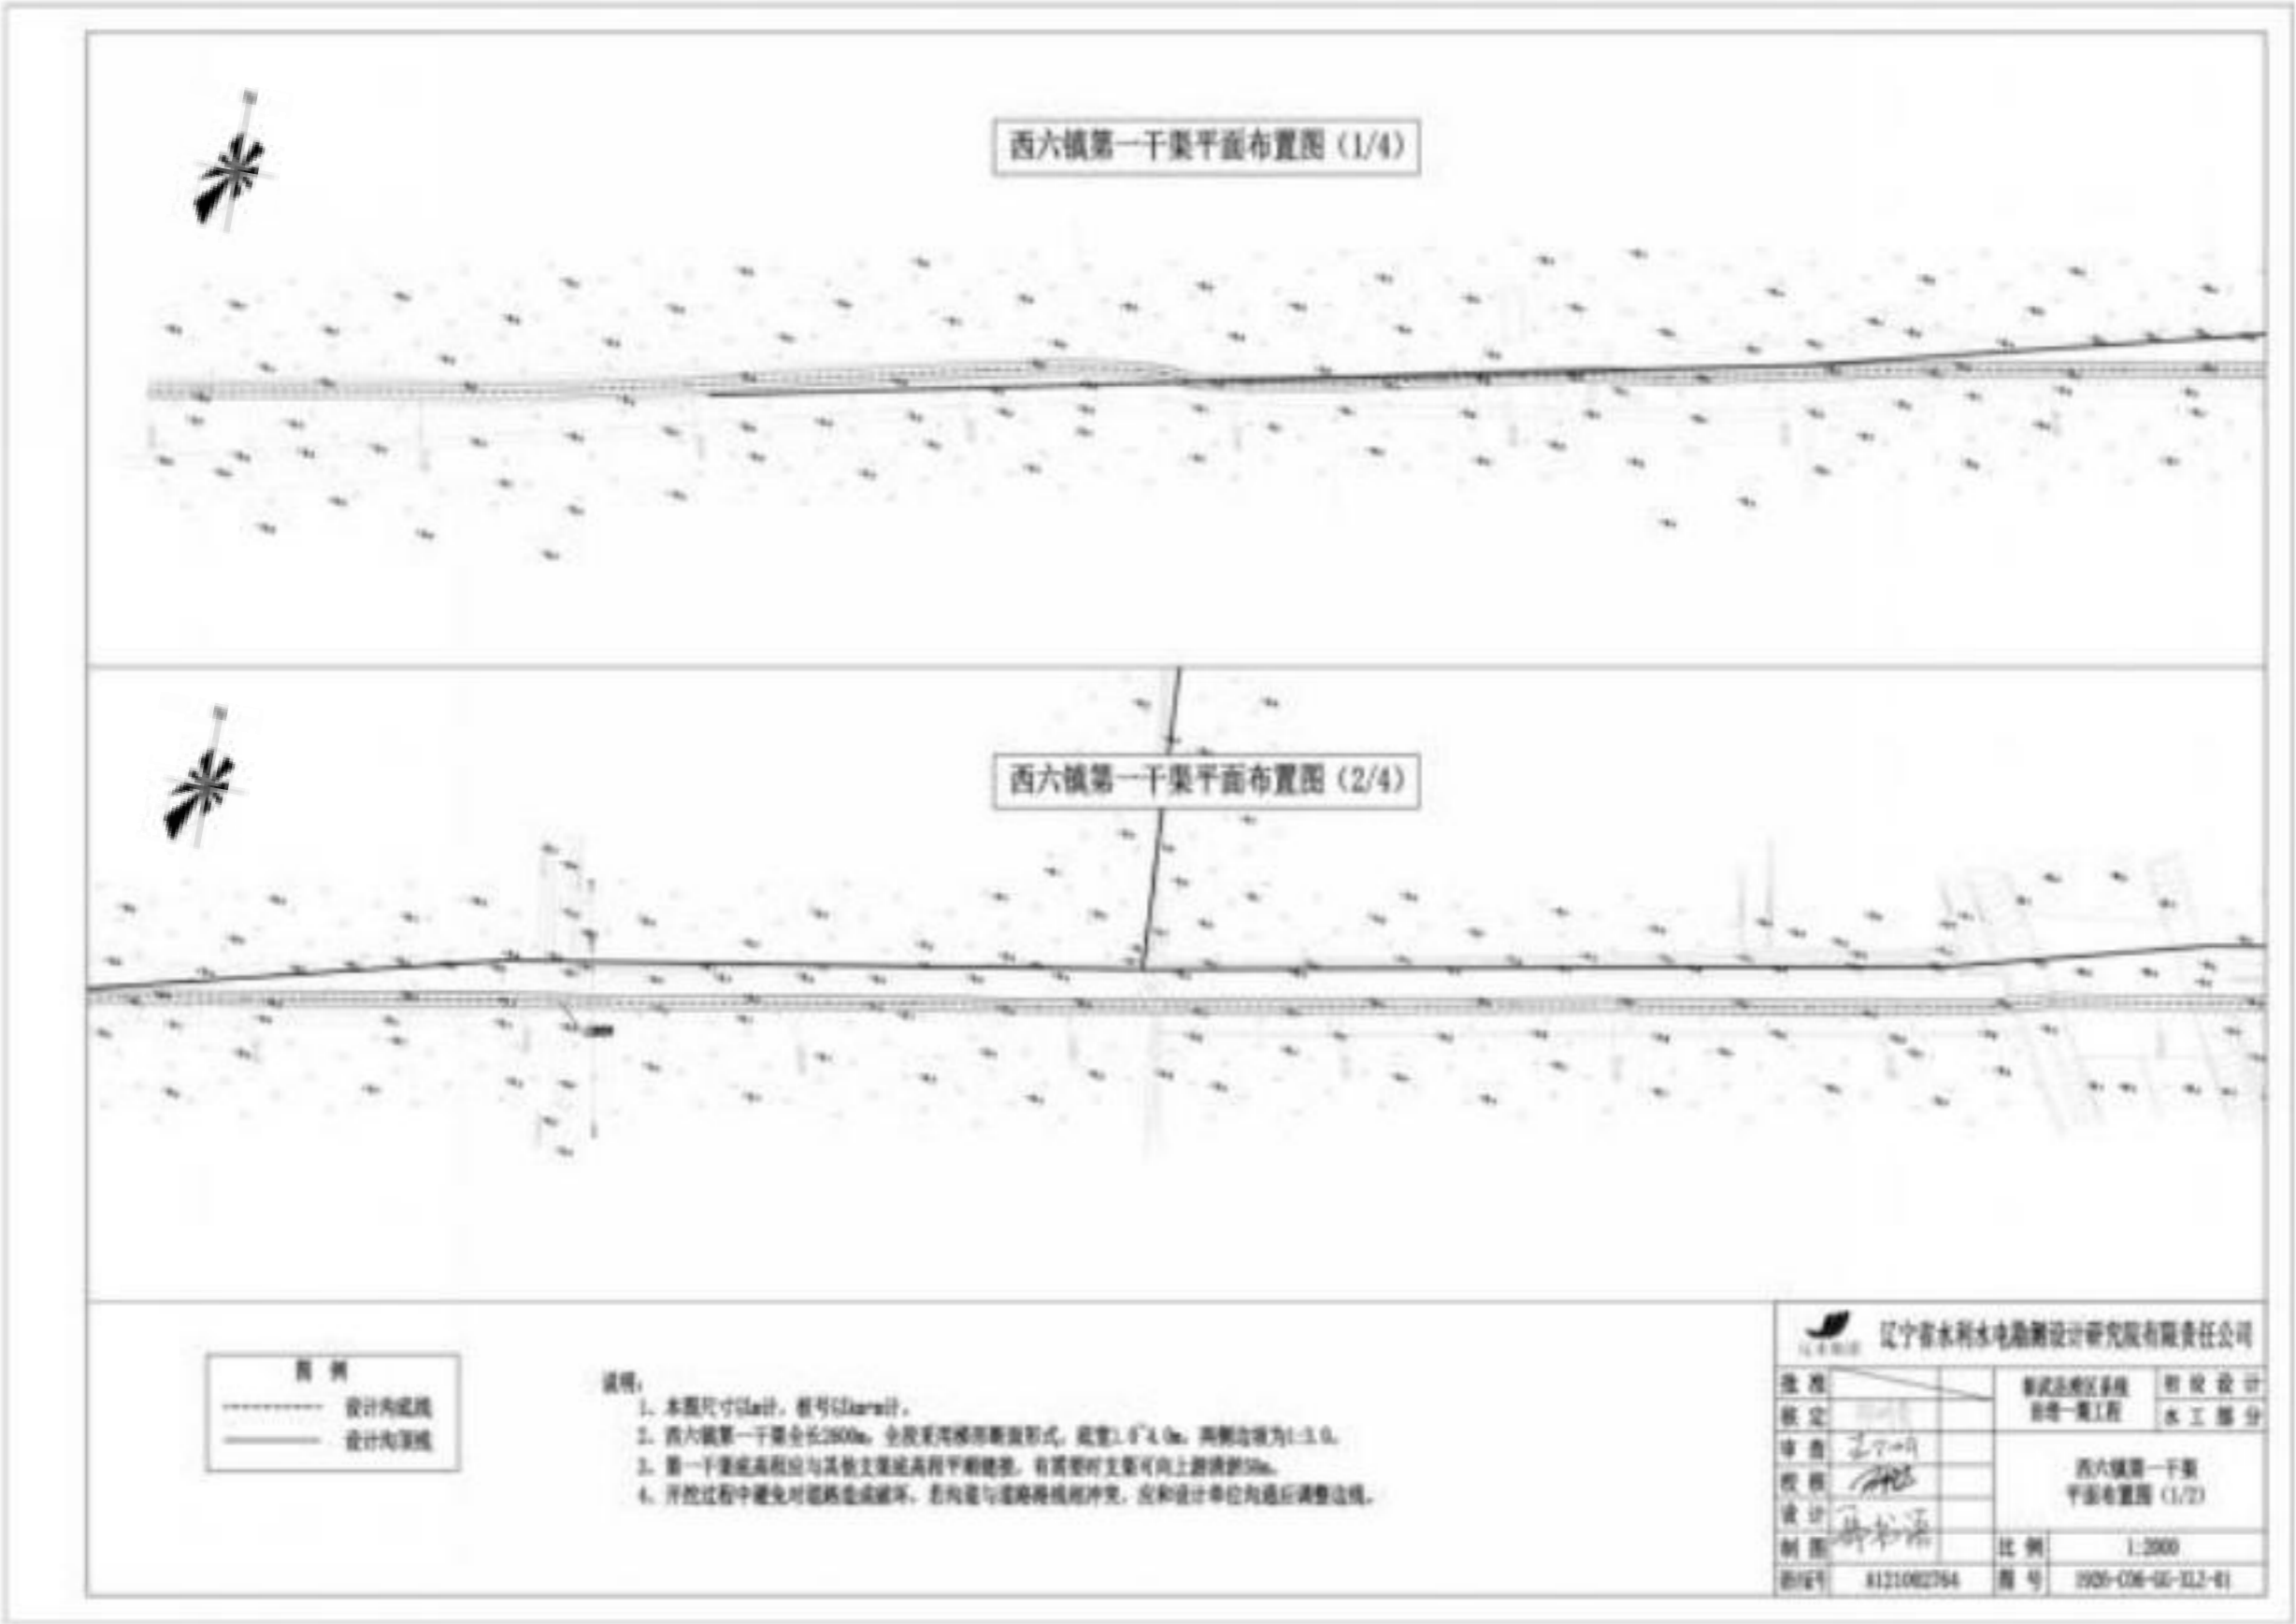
(1) 西六家子镇第一干渠平面布置图
